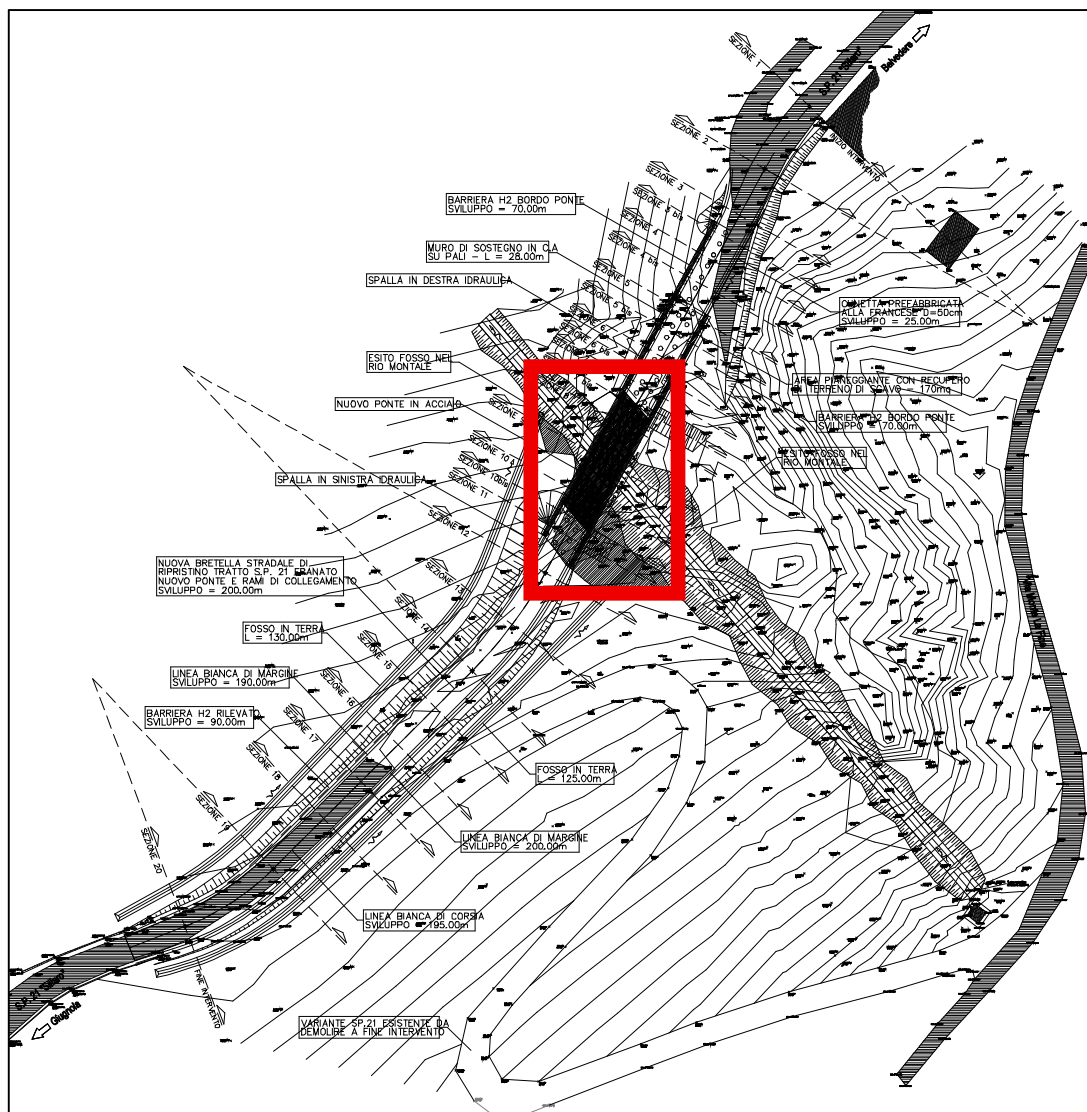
Planimetria con ubicazione della nuova strada con indicato il tratto occupato dal ponte.
